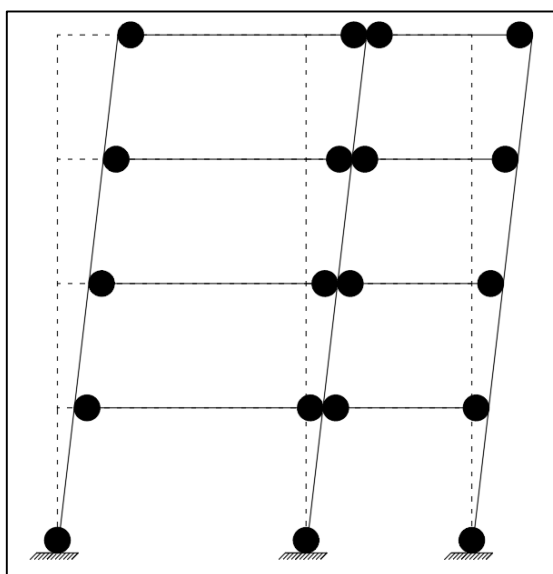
Mecanismo de colapso desejável de estruturas (Lopes, 2008).
